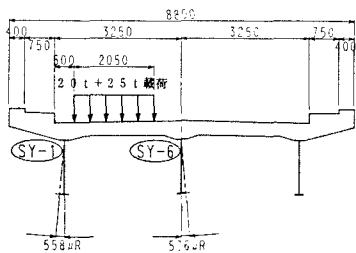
正徳橋の載荷車輛配置及び傾斜計配置図
